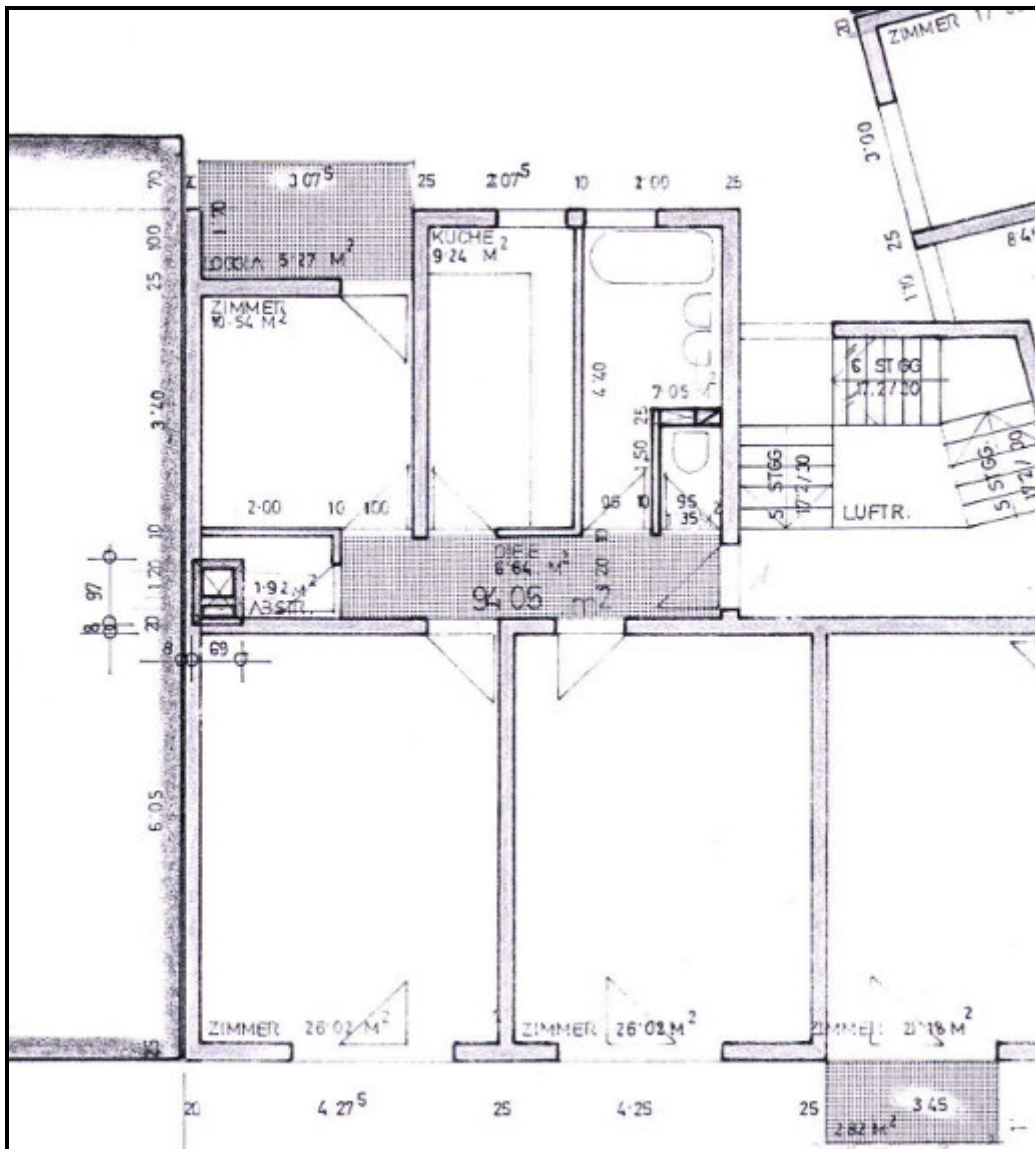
Grundrissplan Wohnung Top W 4 - Bauakt
